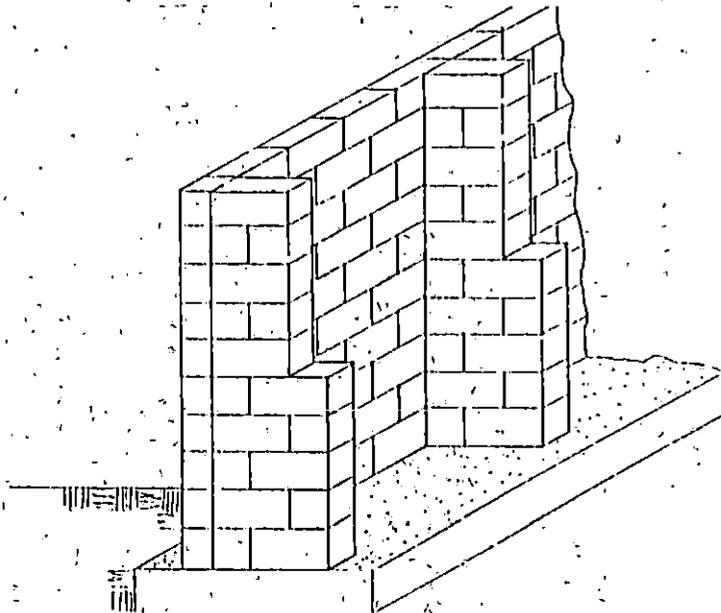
Esquema de un muro de bloque con contrafuerte
